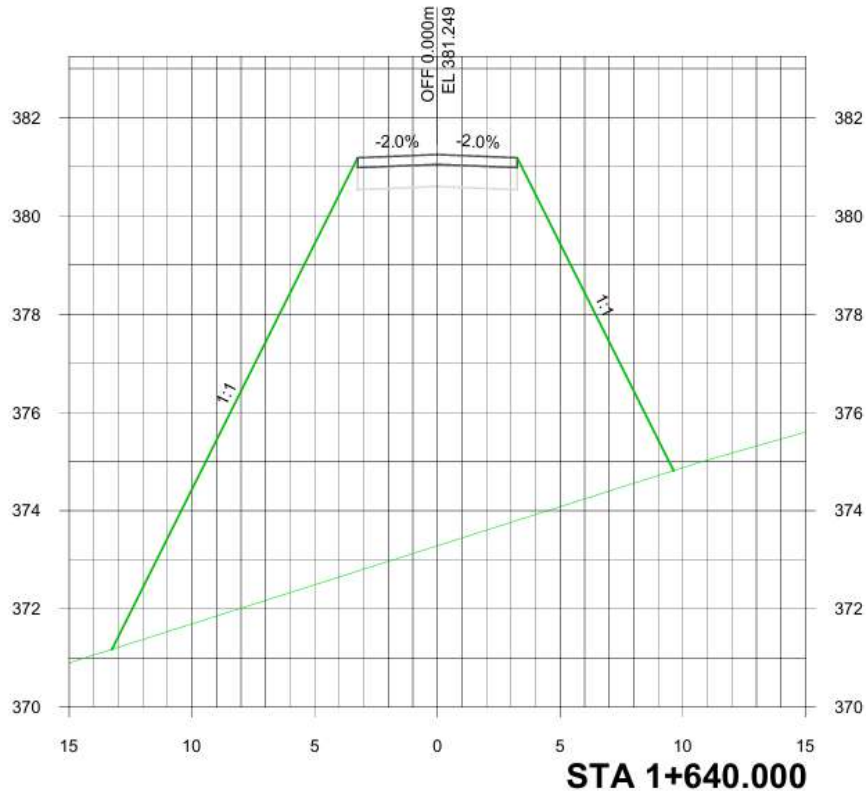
Perfil transversal EJE 14: STA 1 + 640,000
